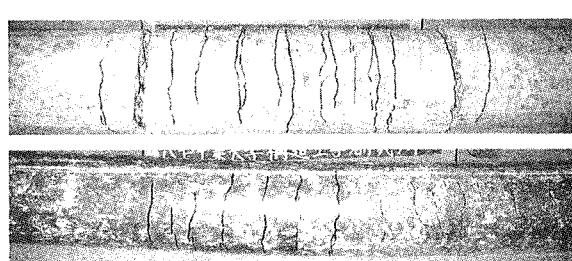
RCFT(下)・CFT(上)曲げ試験体の破壊
